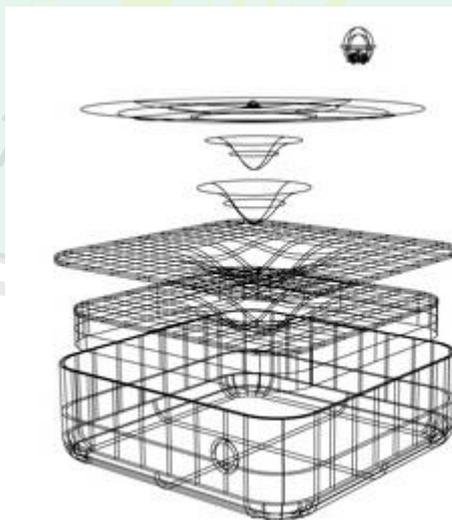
Roof Garden Sebagai Media Edukasi dan Pengganti Lahan Terbangun
